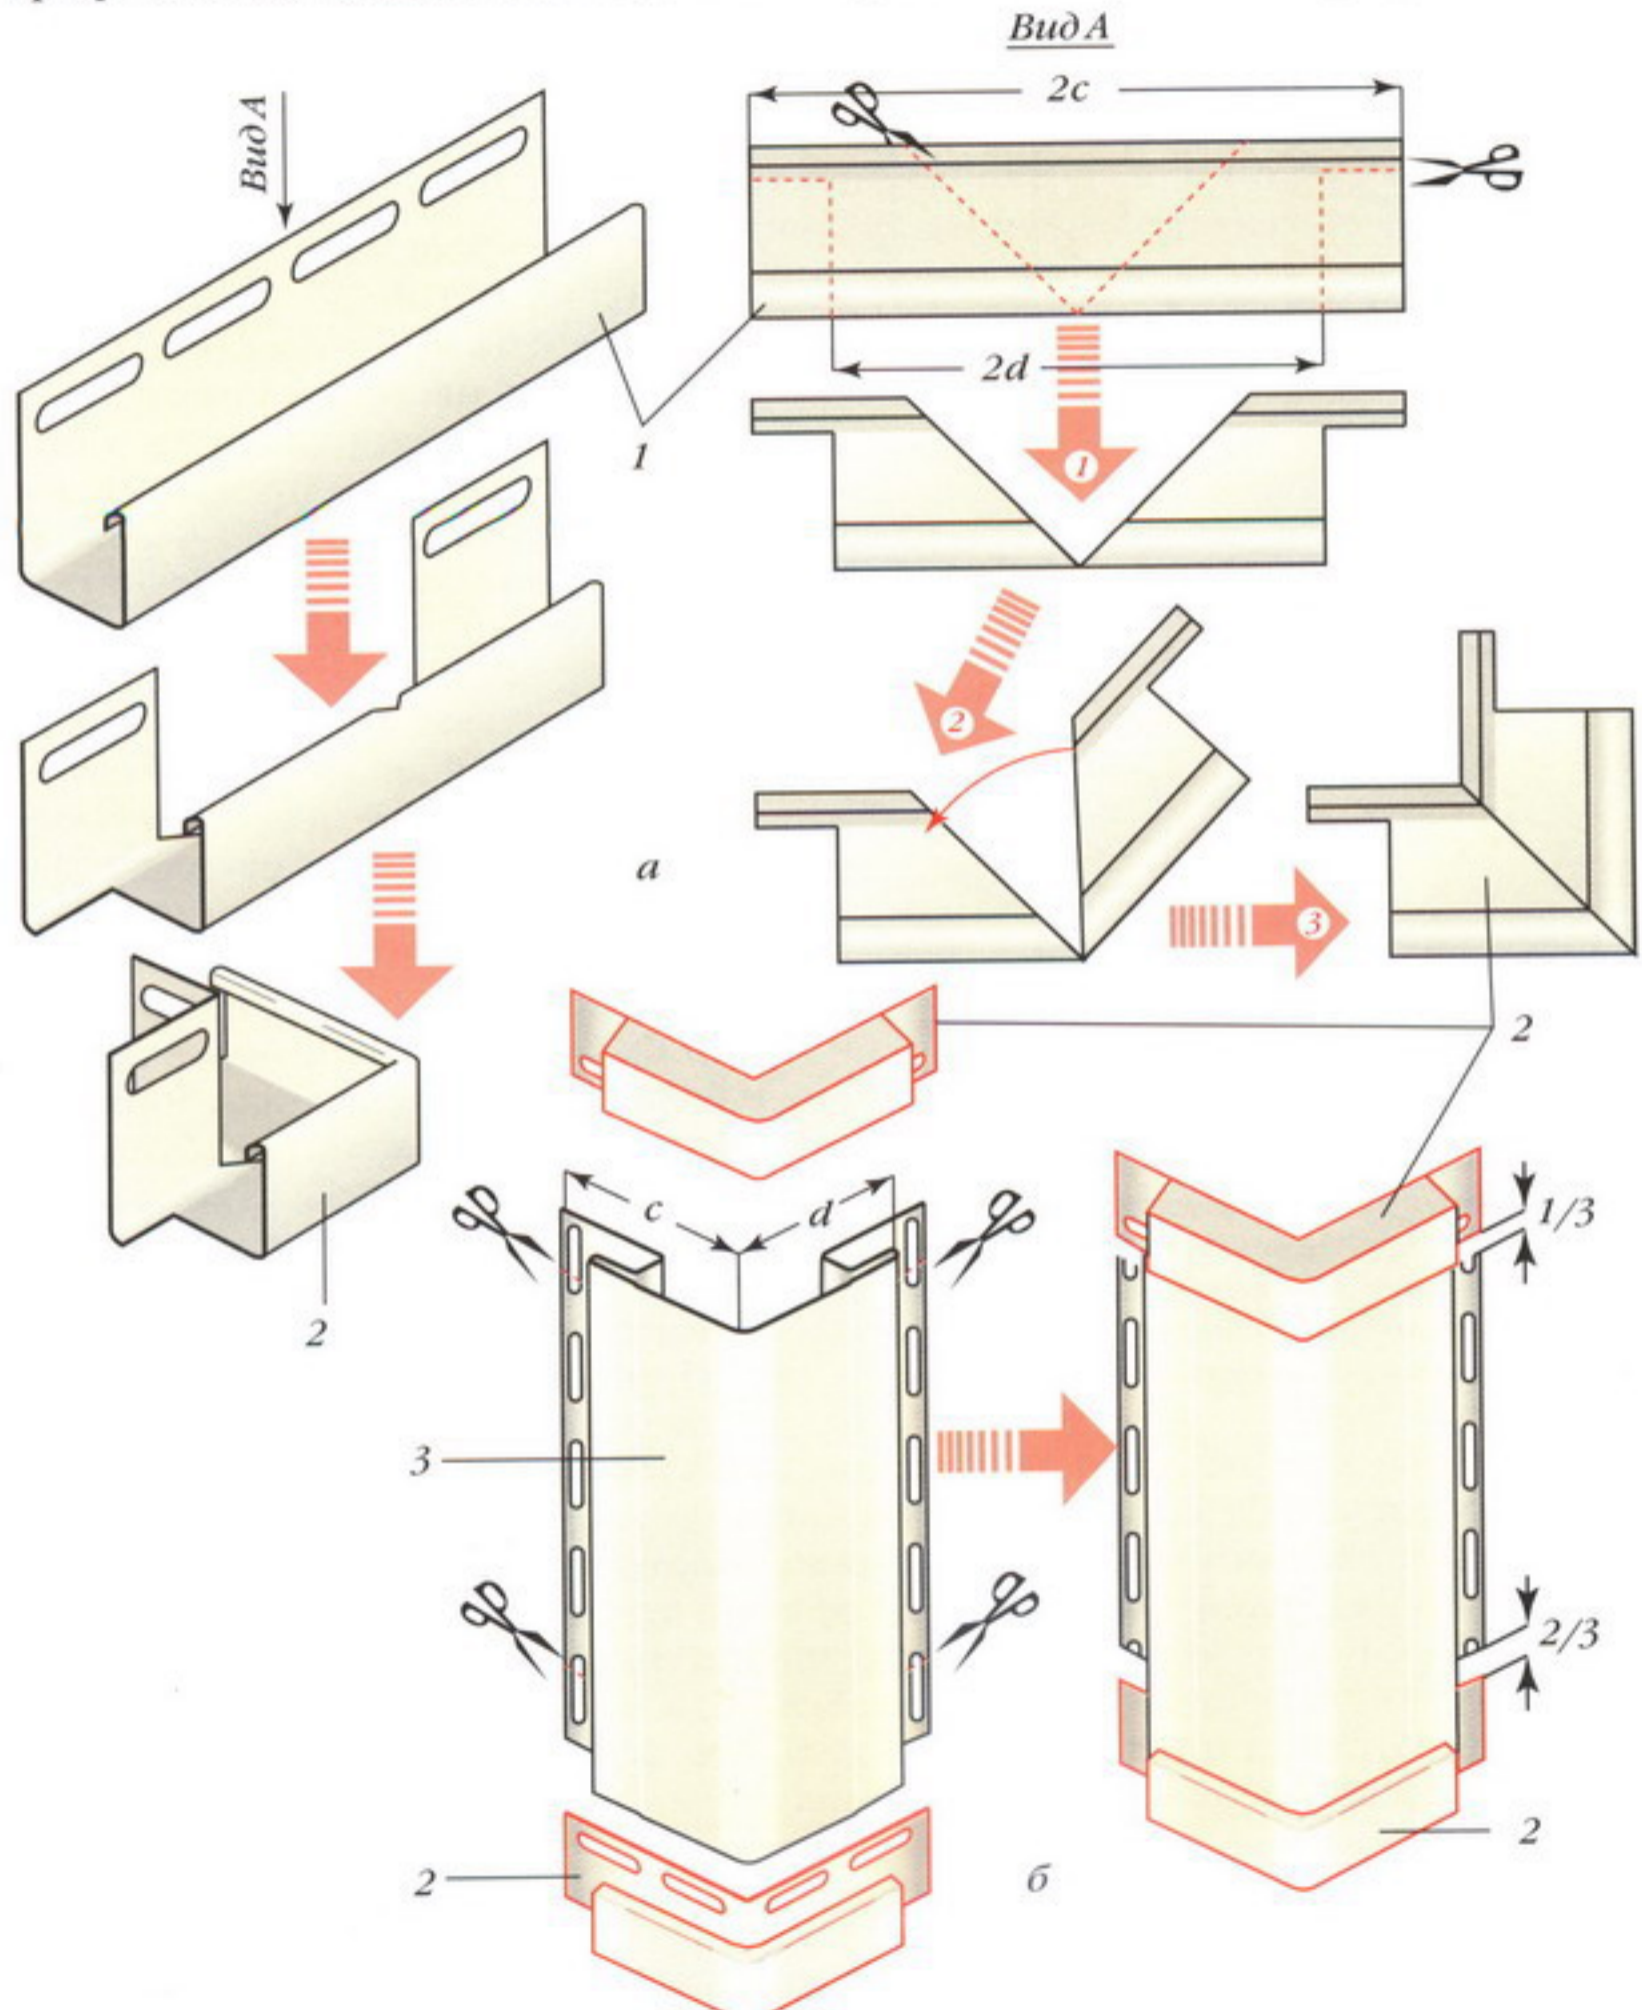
Изготовление и монтаж угловых крышек: а — изготовление крышки из J-профиля; б — монтаж крышек; 1 — J-профиль; 2 — крышка; 3 — угловой профиль
